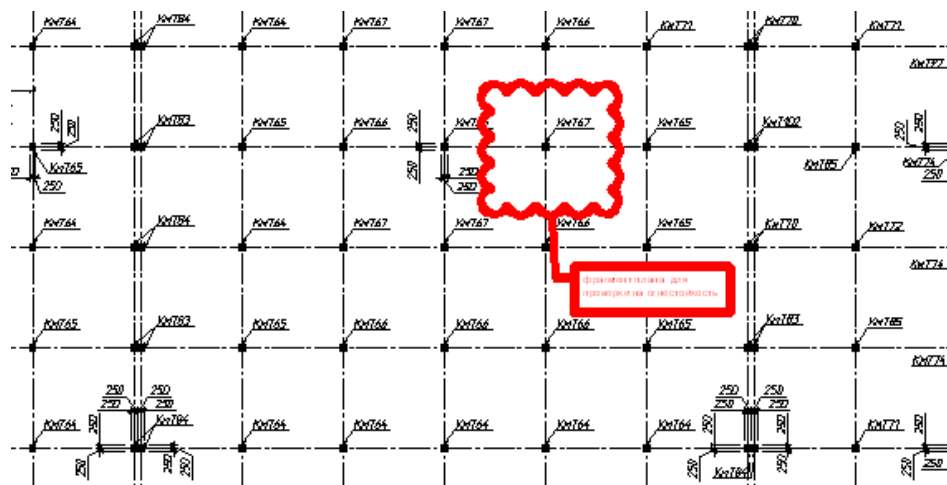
Розташування фрагменту будівлі верхнього ярусу
